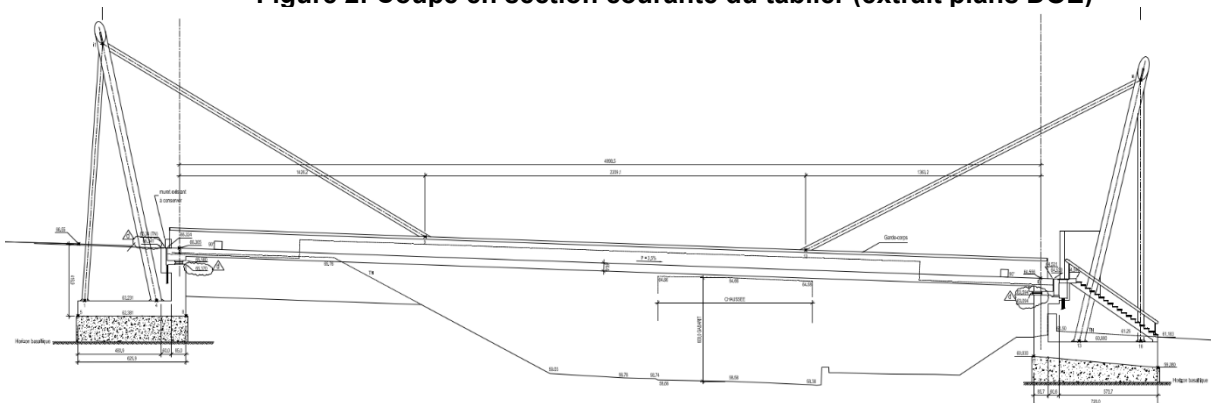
Profil en long de l'ouvrage (extrait plans DOE)
